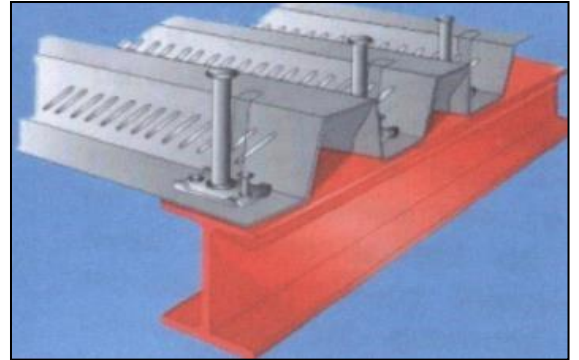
schéma latéral d'assemblage (poutre – plancher)
